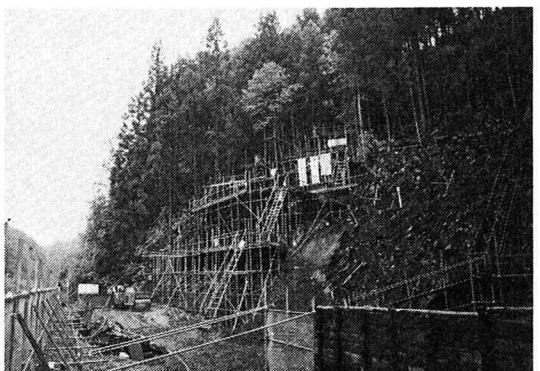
トンネル出口斜面での縫地ボルト施工のための鋼管パイプステージ
